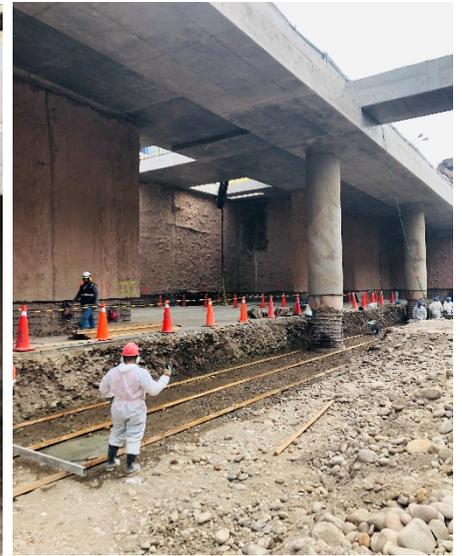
Durante armado de losa de la Estación 19-Nivel Vestíbulo
